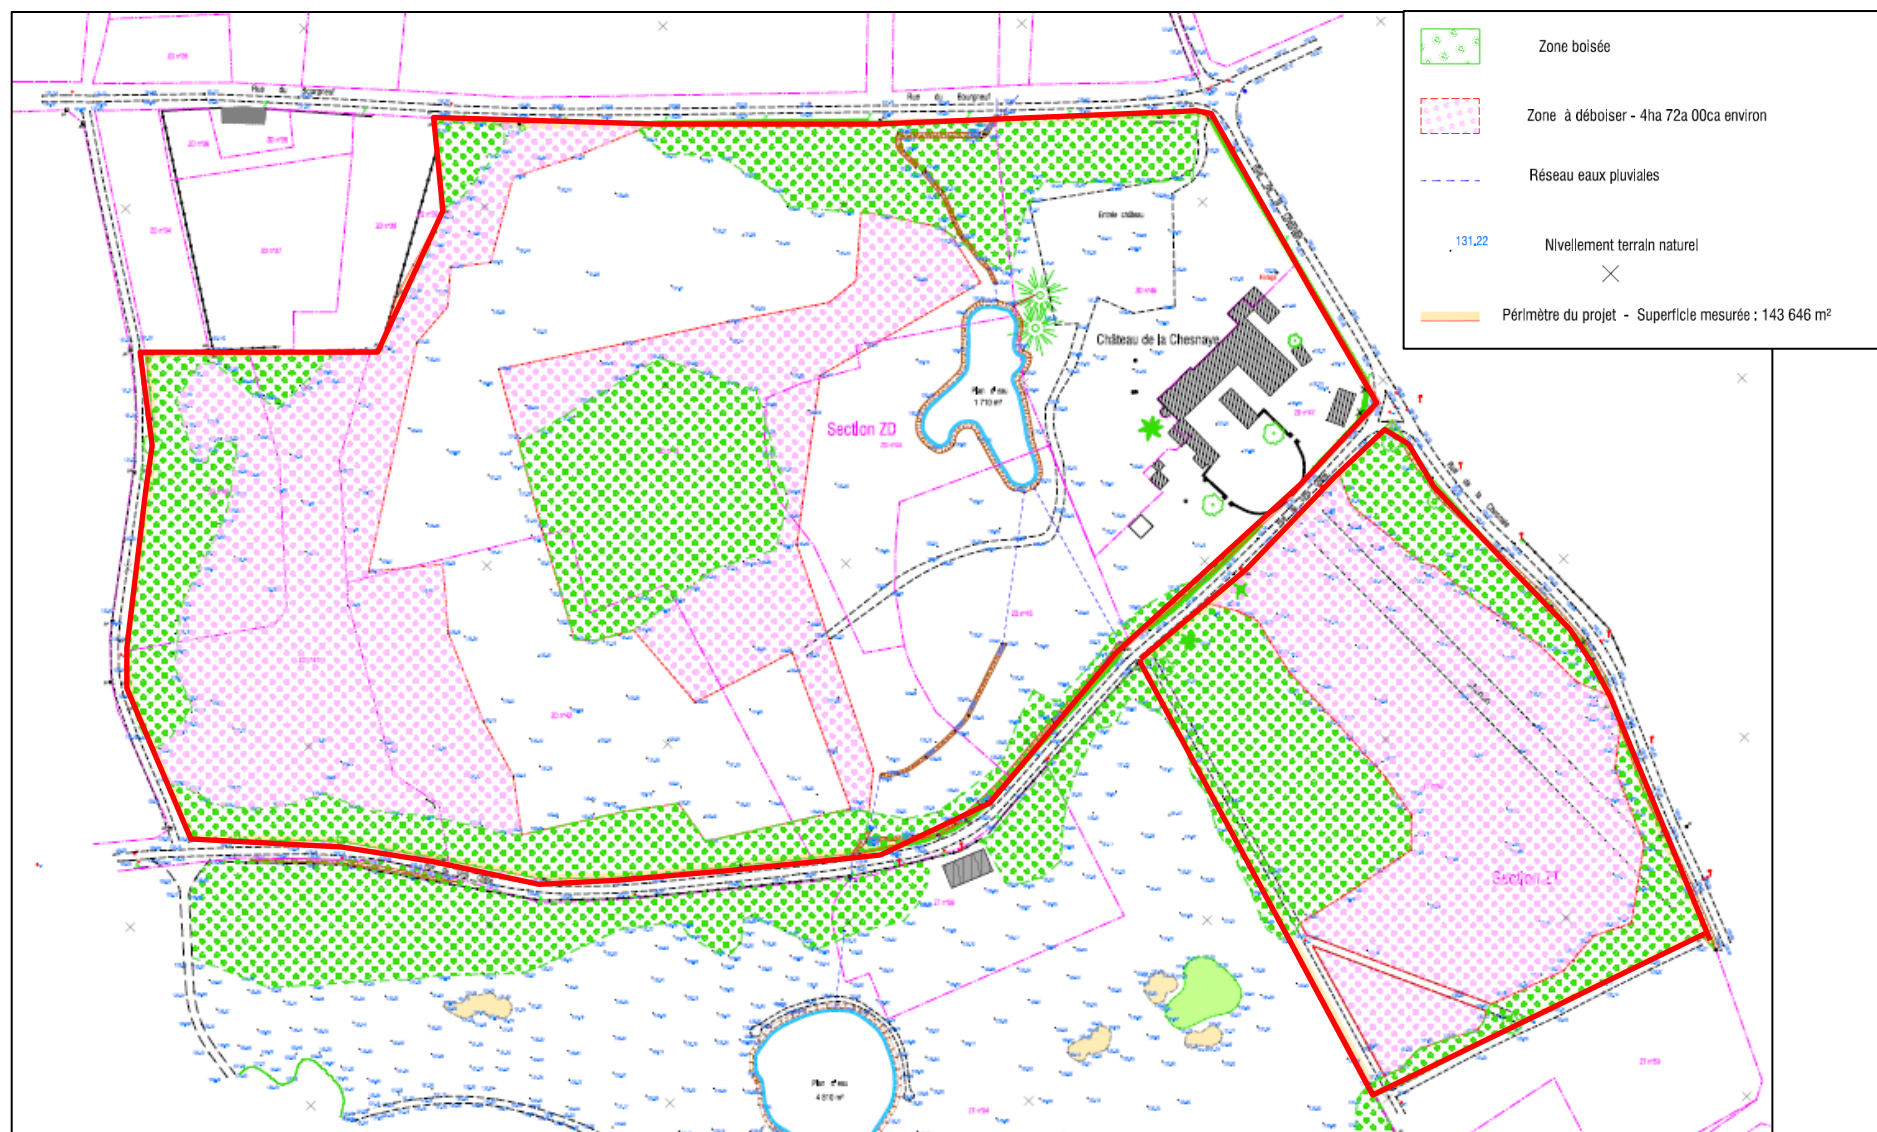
Extrait du plan topographique – AB Associés – Janvier 2021
